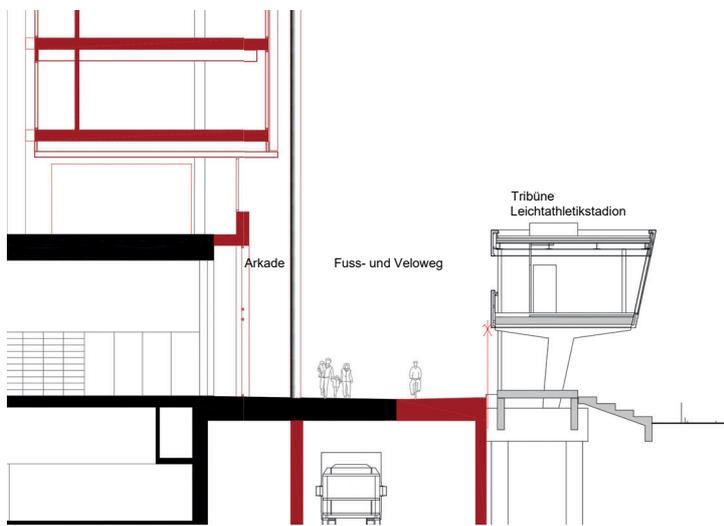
Ausschnitt BGK: Konzept für den Aussenraum nördlich Stadion (Schemaschnitt Gebäude gemäss
